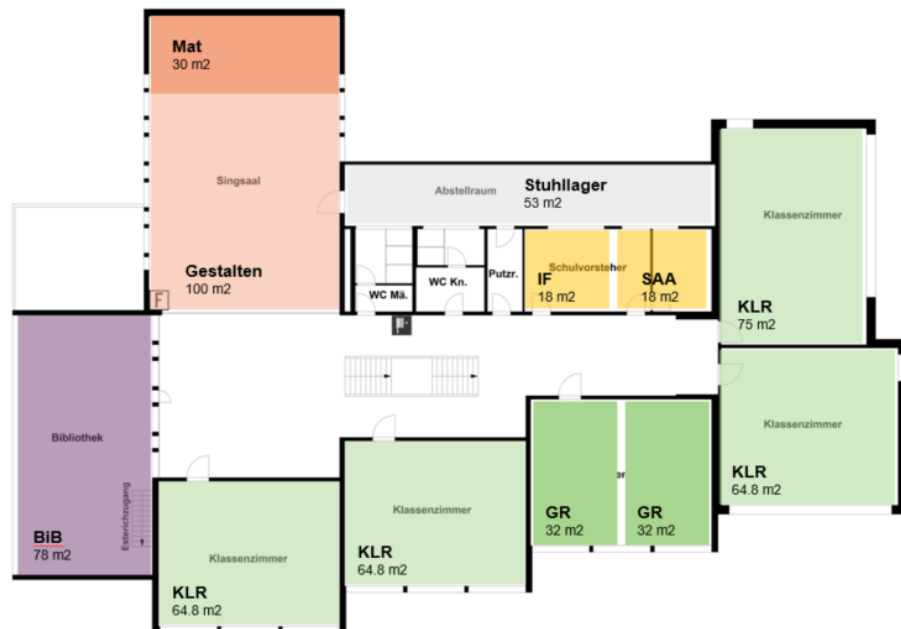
Nutzungsplan Grundriss Obergeschoss, saniert
